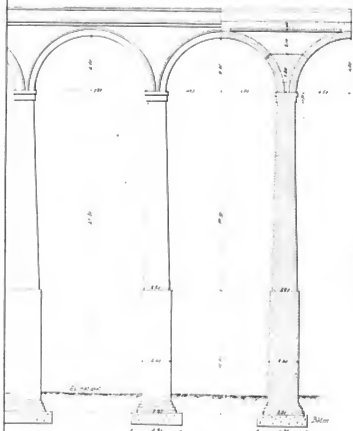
Coupe longitudinale suivant CD & 1/2 par 1/2
